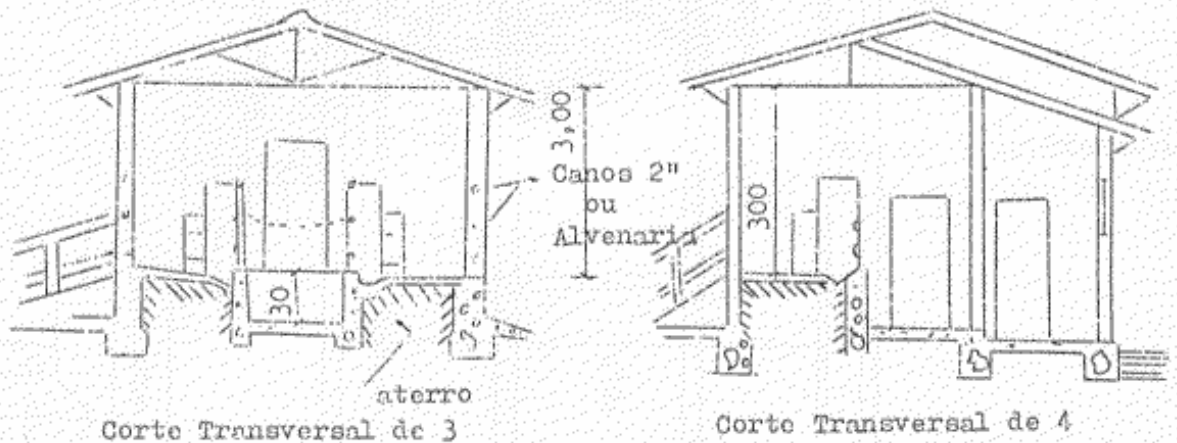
Detalhes da Construção da Sala de Ordenha
